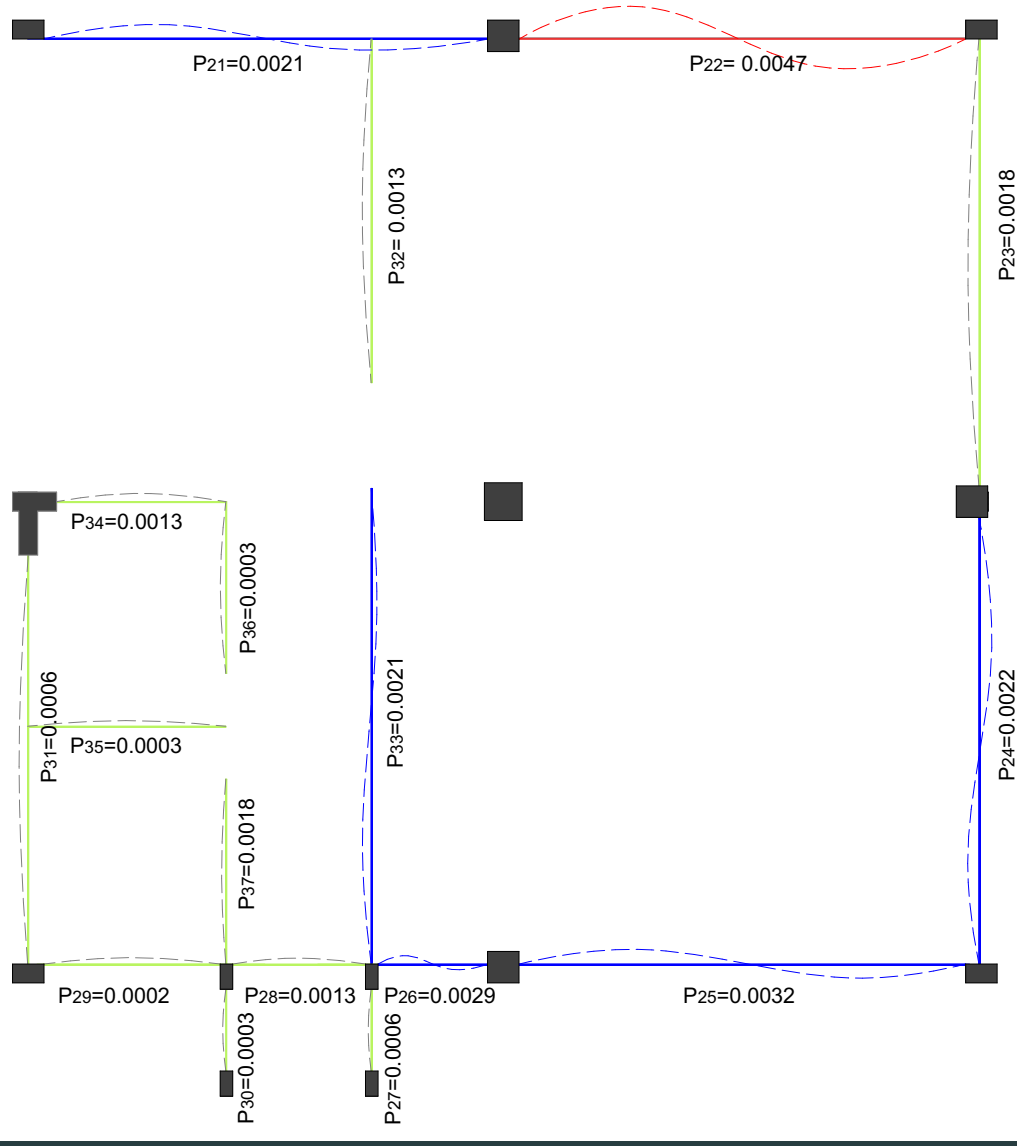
Esquema del espacio en planta de la deformación en paredes _ Planta Baja _ N= +-0.00.
